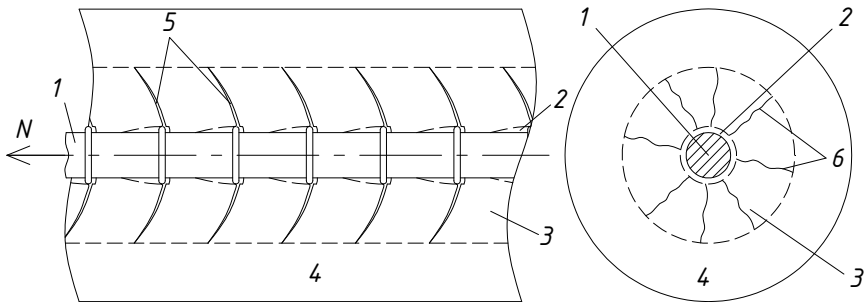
Загальна схема зчеплення арматури з бетоном: 1 – арматурний стержень; 2 – зона зсуву; 3 – зона бетону з тріщинами; 4 – зона неушкодженого бетону; 5 – конічні тріщини; 6 – радіальні тріщини
